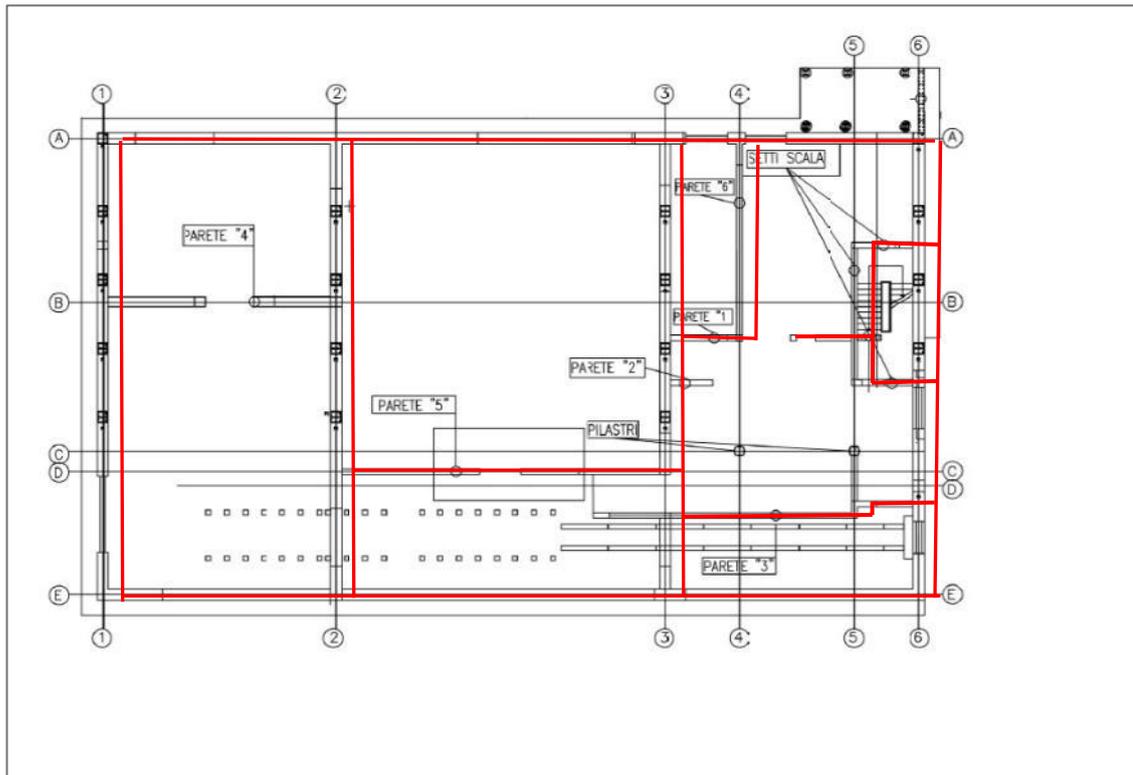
Planimetria di progetto con indicazione (in rosso) delle strutture in elevazione realizzate
